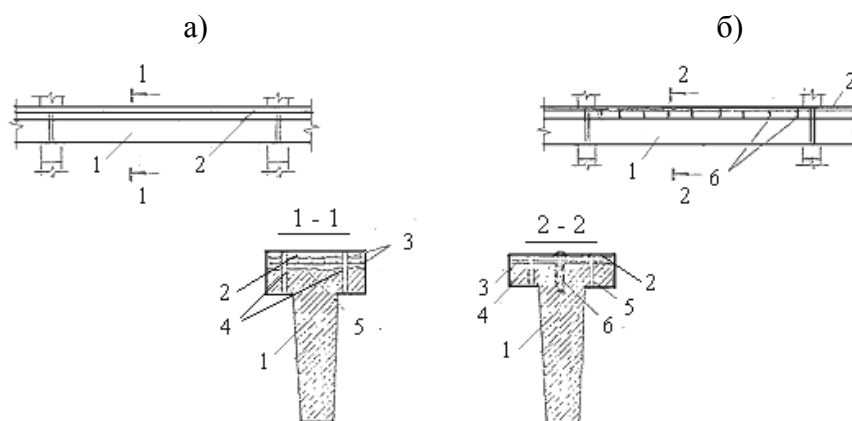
Усиление полок железобетонных подкрановых балок наращиванием из железобетона (а) и листового металла на полимеррастворе
